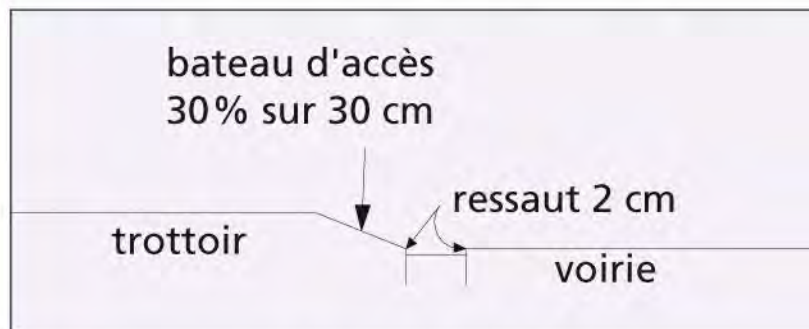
coupe transversale d'un bateau d'accès infranchissable. © GAMAH
